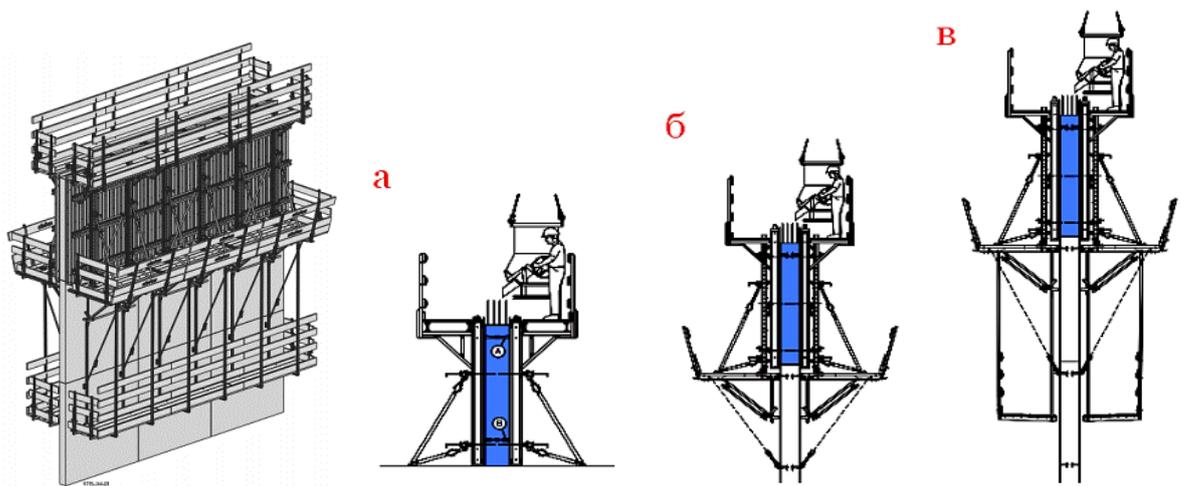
Общий вид и схема поярусного бетонирования с использованием подъемно-приставной опалубки [3 – 13]
